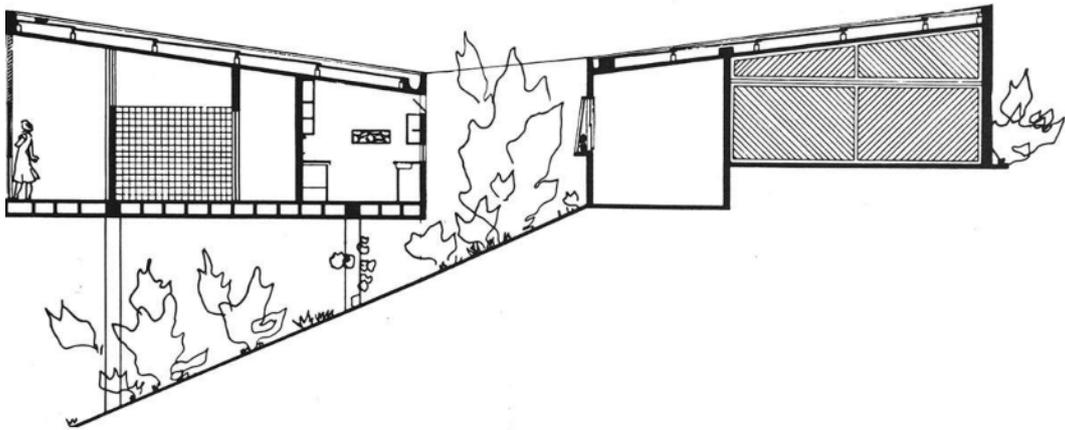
alzado de la Casa Carmen Portinho, Revista Projeto
